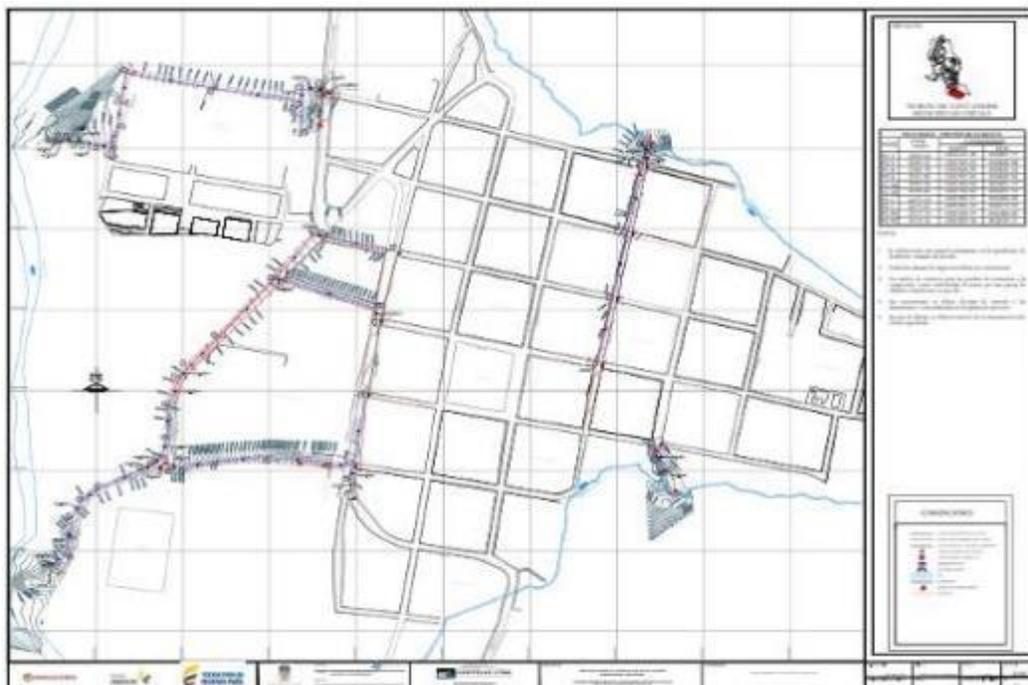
a 137. Las figuras muestran los principales planos trazados para la ejecución de la obra. Fuente: CSSI, Pasante.
